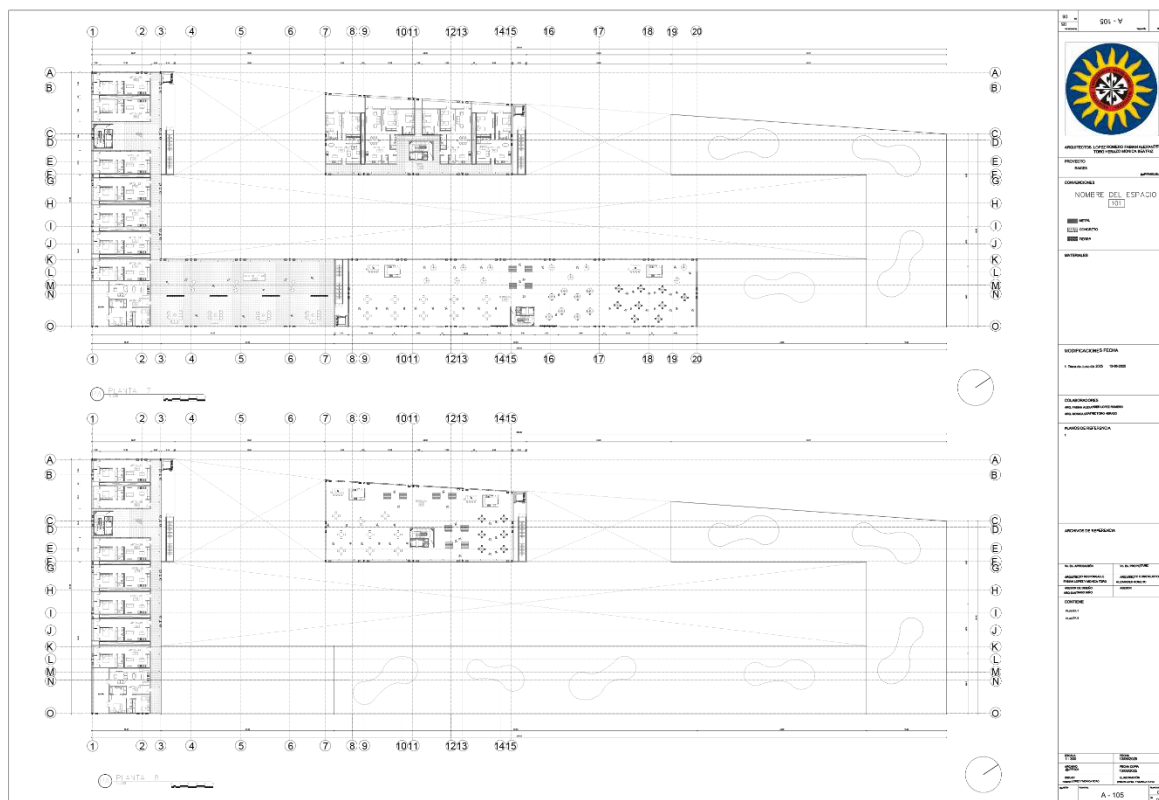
Planimetría Planta 7-8. Fuente: Elaboración propia.
